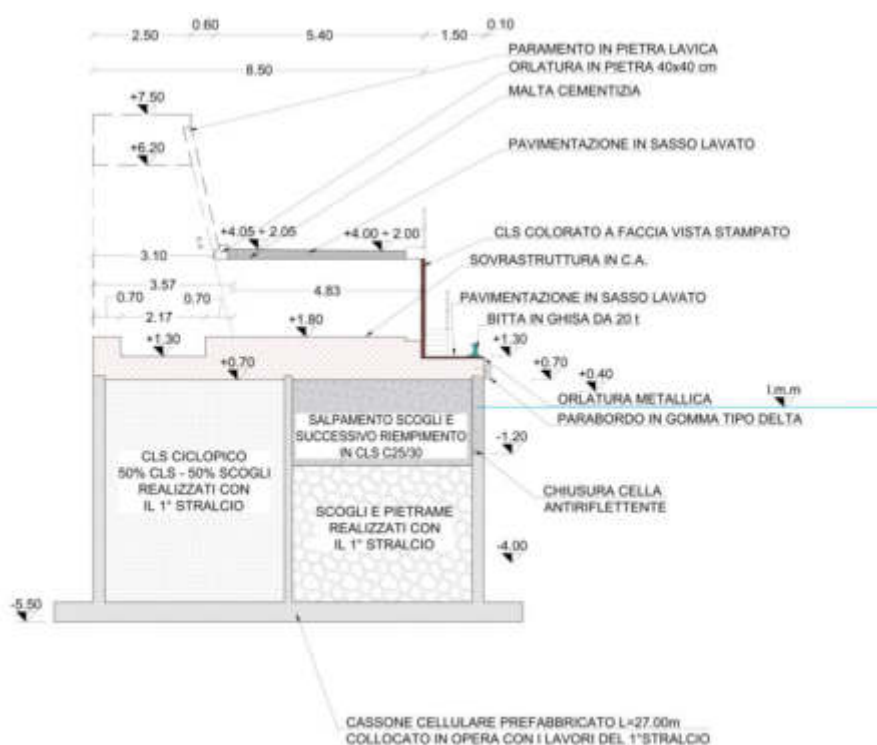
Sezione trasversale cassone esistente – sovrastruttura - muro paraonde.
